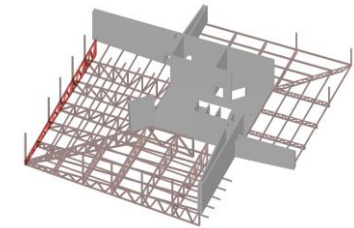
Ubicación viga en celosía 1 en estructura de P2.
